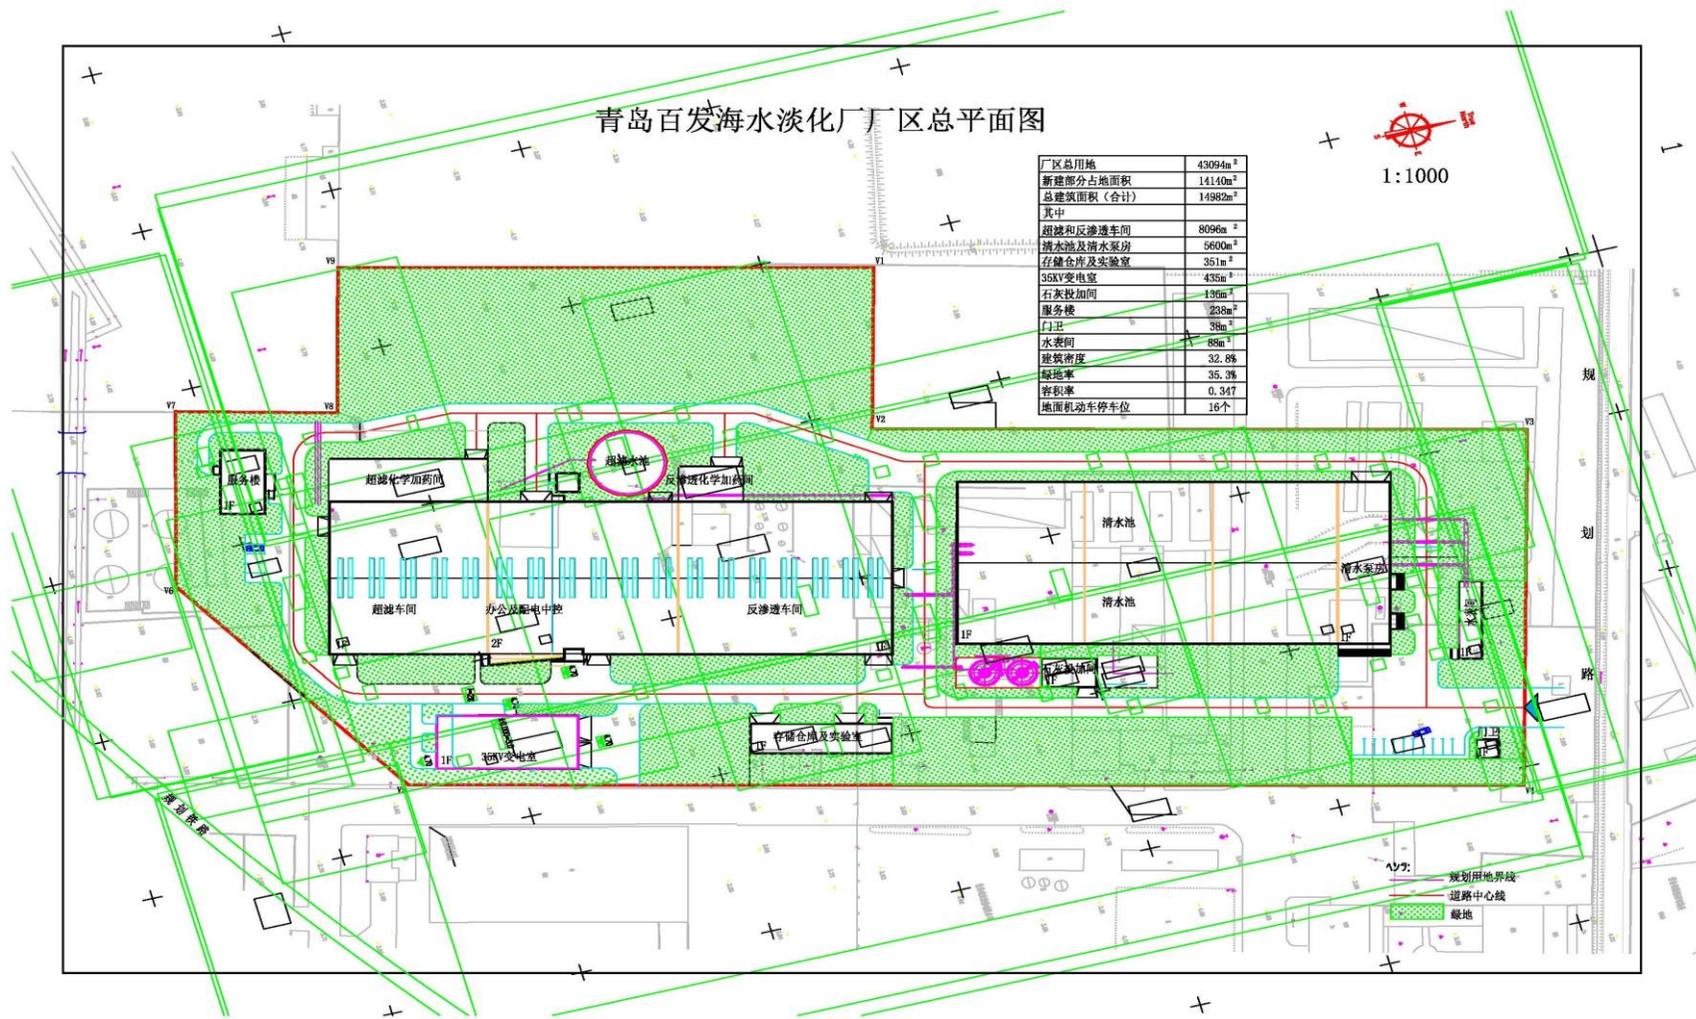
青岛百发海水淡化厂现有工程总平面布置图
